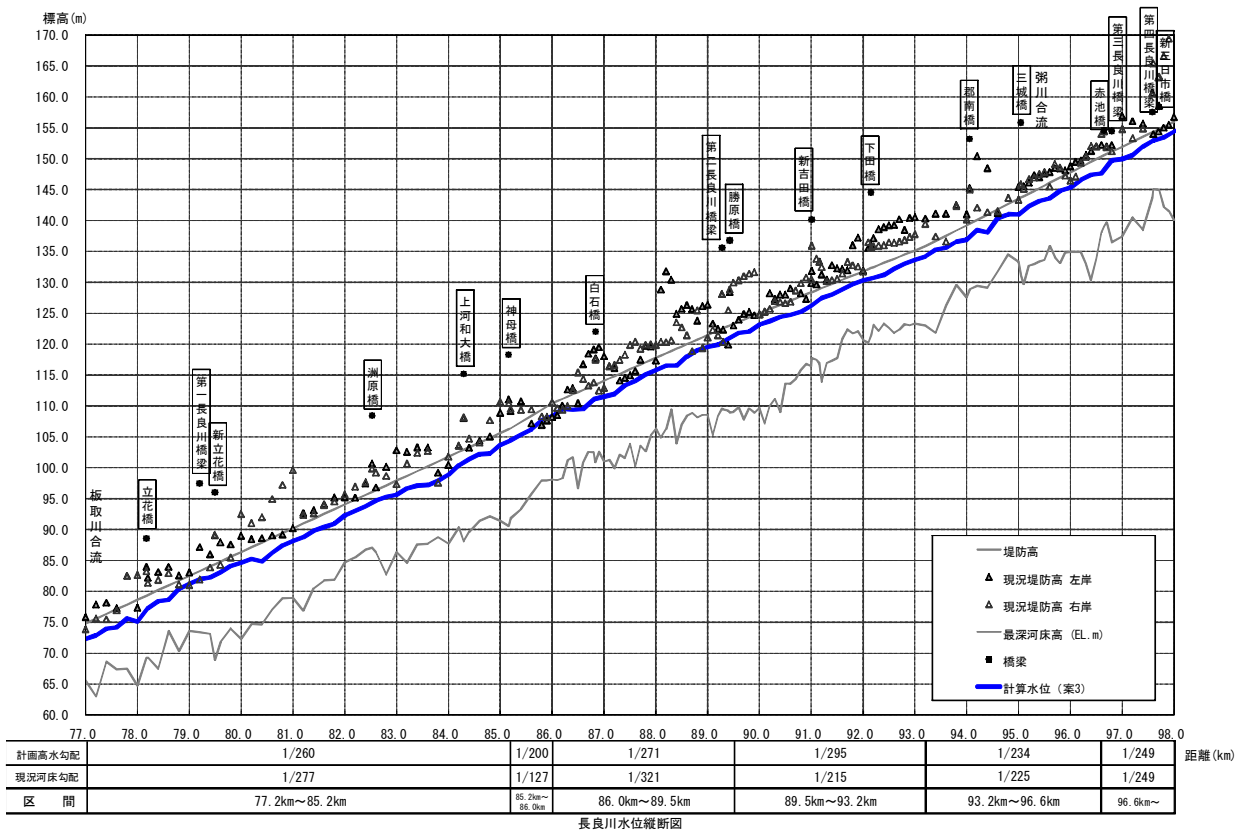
河道改修+遊水地案 縦断面図(77km~98km)
